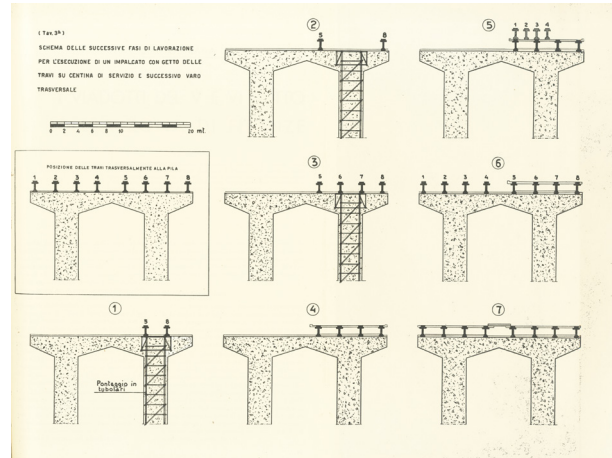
Ponti dell'Autostrada del Sole al Mugello, schema fasi della costruzione (Archivio SIXXI).
